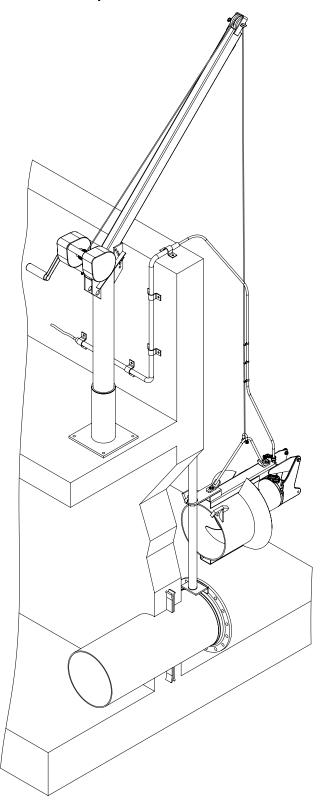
Esempi d'installazione con dispositivo di sollevamento ABS 5 kN
